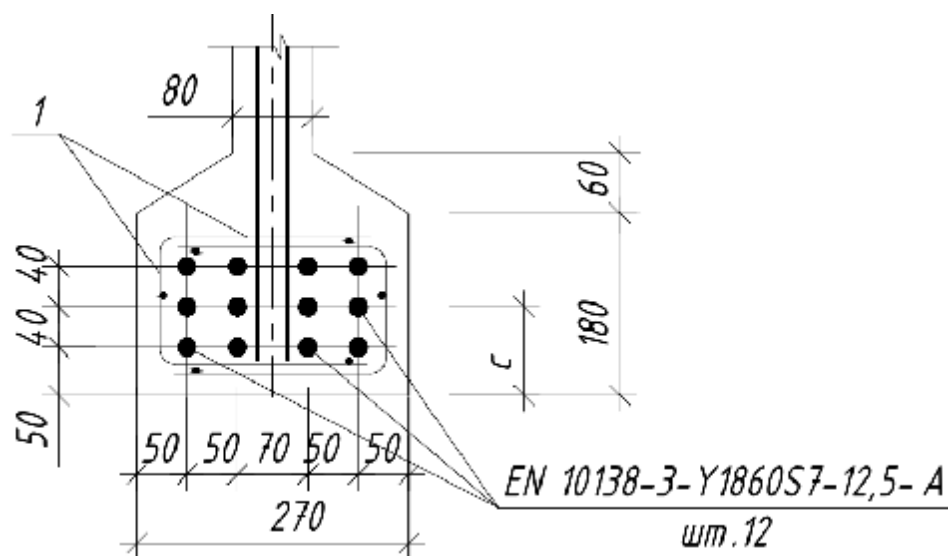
Принятое размещение напрягаемой арматуры в сечении балки
